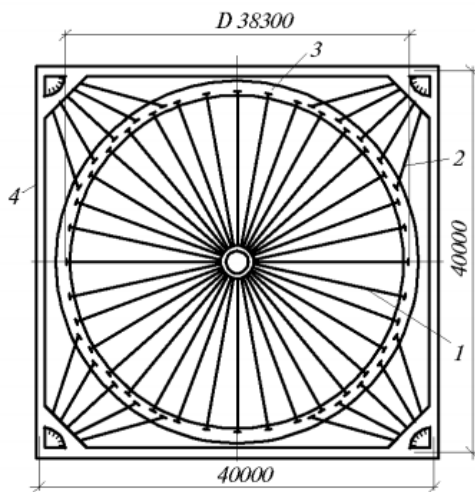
Железобетонная висячая оболочка, квадратная в плане:
